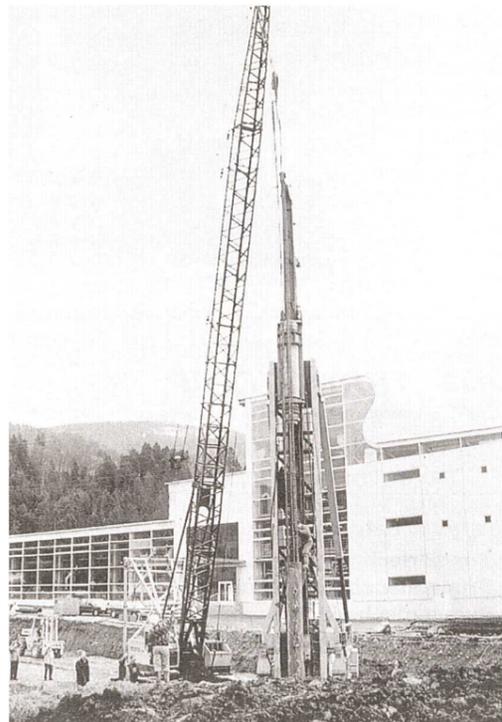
Einheben des Bewehrungskorbs mit Wärmetauscherrohren für einen Ortbeton-Bohrpfahl (Energiepfahl) in Vorarlberg/Österreich
